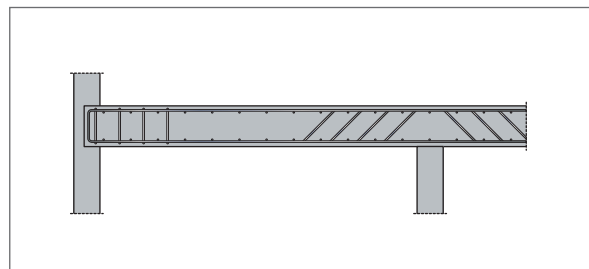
Flachdecke mit Bügeln und Schrägaufbiegung
